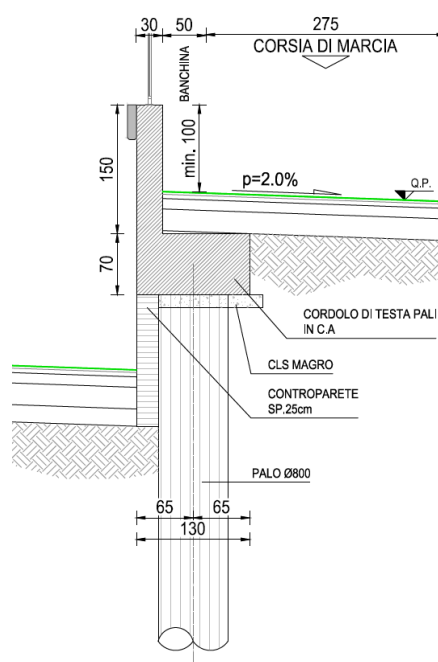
Particolare tipologico paratia pali con muro stradale
